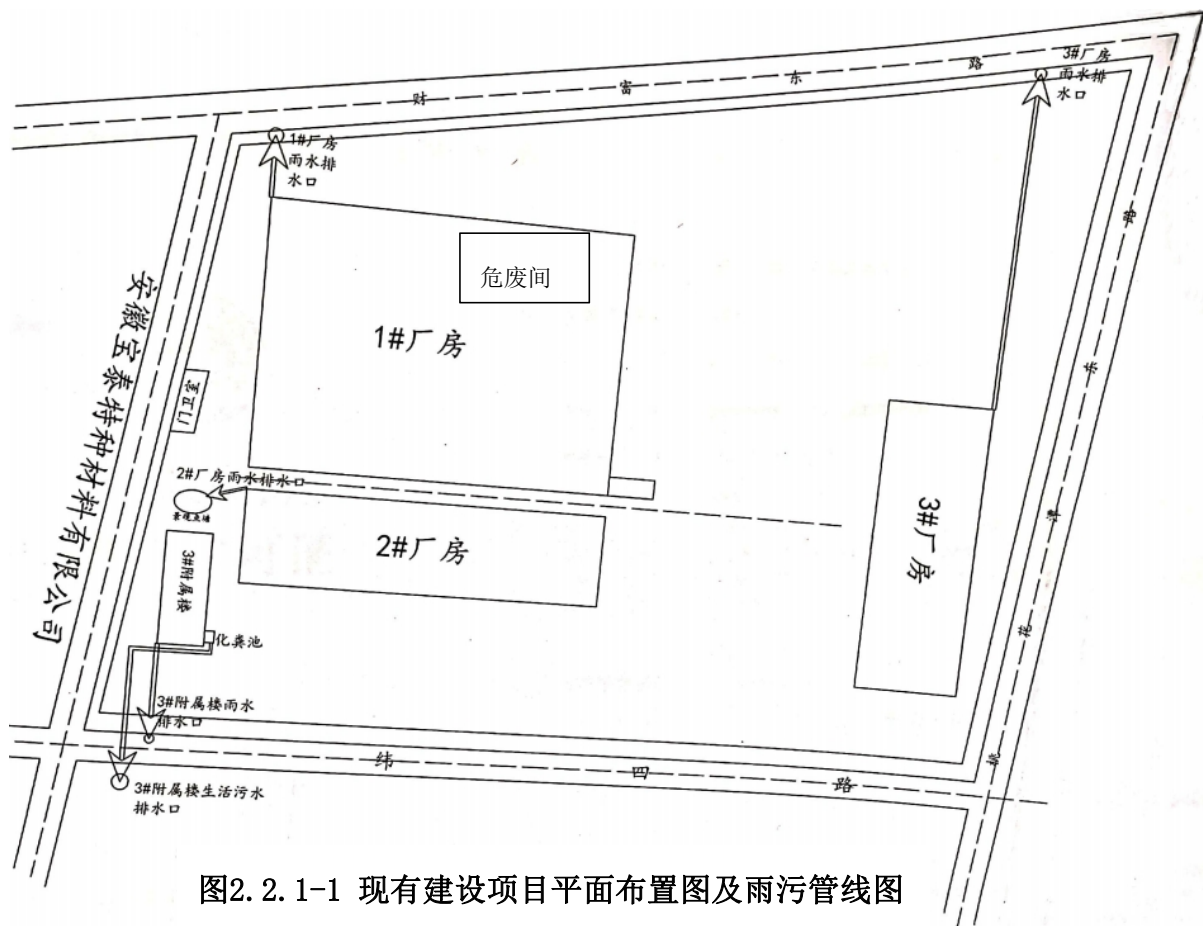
现有建设项目平面布置图及雨污管线图
